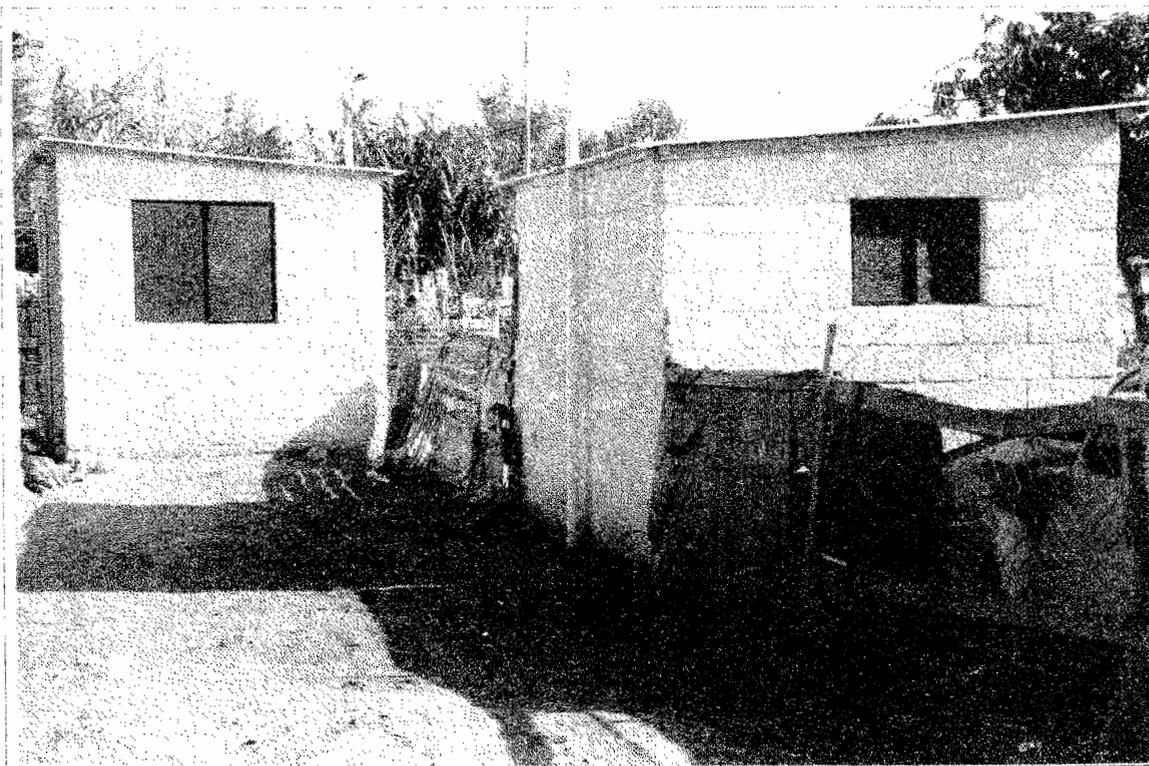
Caseta sanitaria en sistema constructivo en bloques de cemento. III Región.
